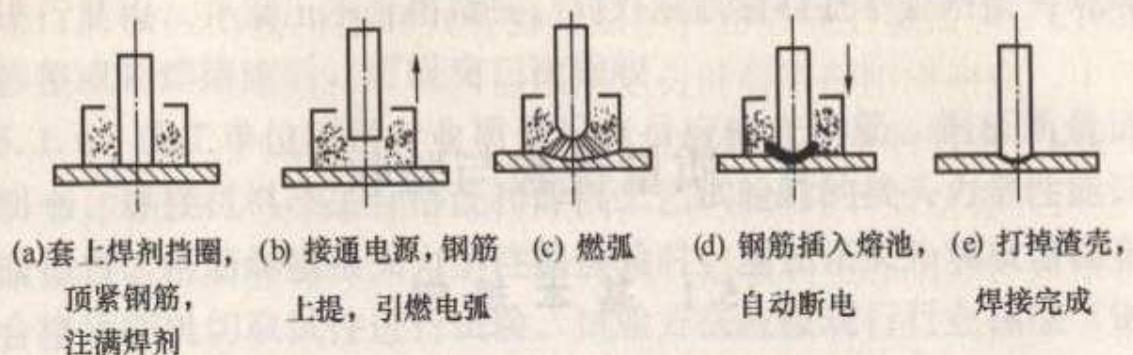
预埋件钢筋埋弧螺柱焊示意
